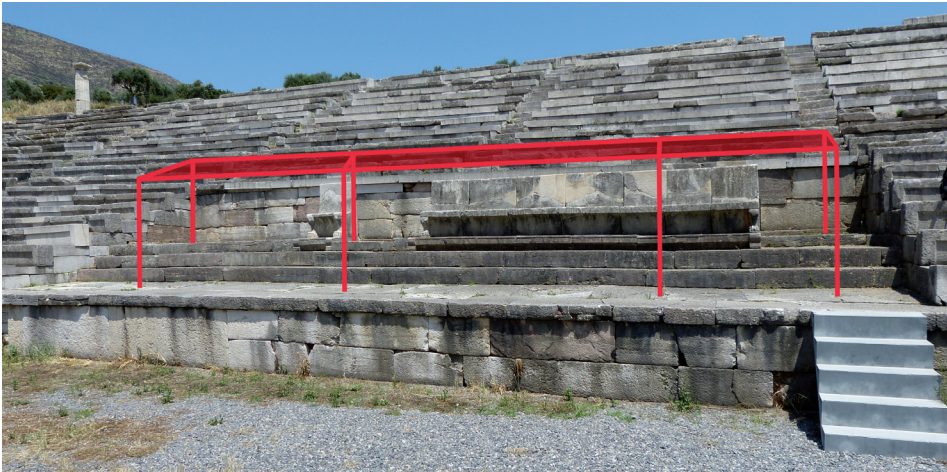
Proposition de protection contre le soleil sur la loge d'honneur du stade de Messène (Grèce) (clichés et montage S. Madeleine).
